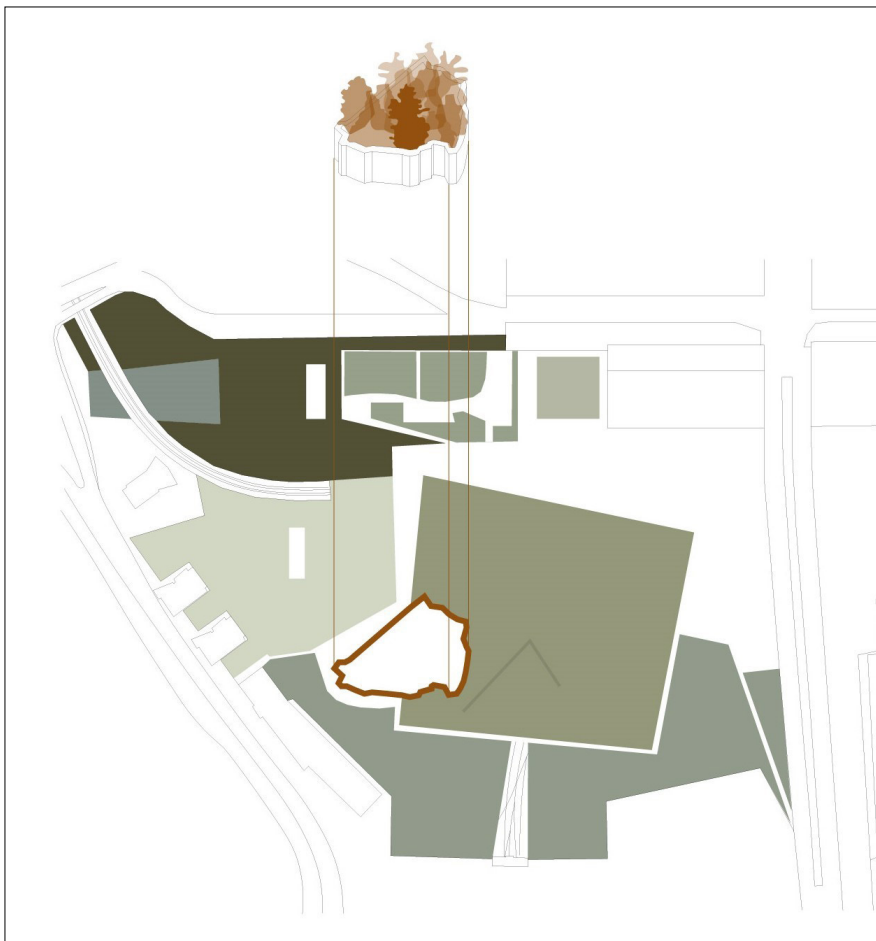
Gilles Clément, Parc Henri Matisse, 1996. Planimetria generale.
